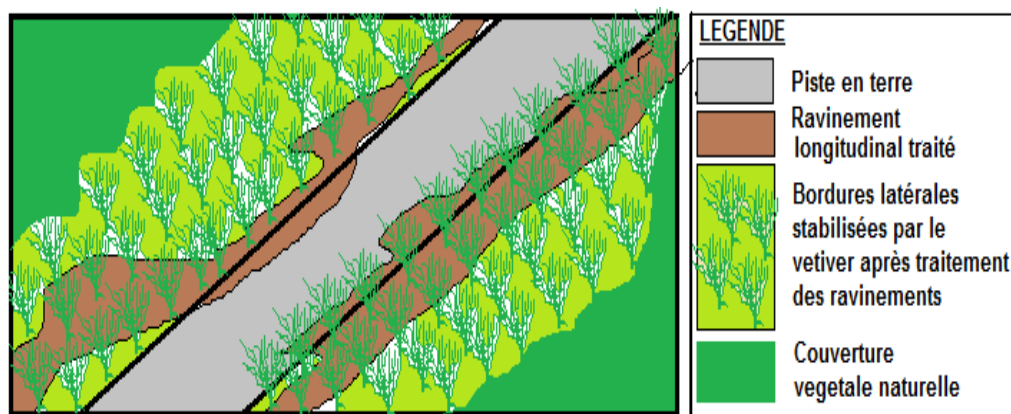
Remblayage et stabilisation des rebords d'une section de piste en zone assez plane, affectés par les ravinelements longitudinaux
